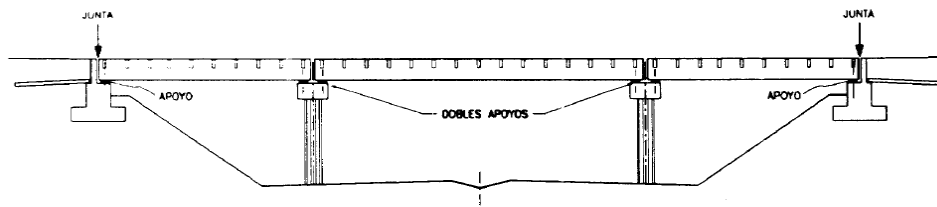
Rodríguez C. (2000), puente mixto tablero de vigas múltiples, ilustración, recuperado de Guía para la concepción de puentes en carreteras
